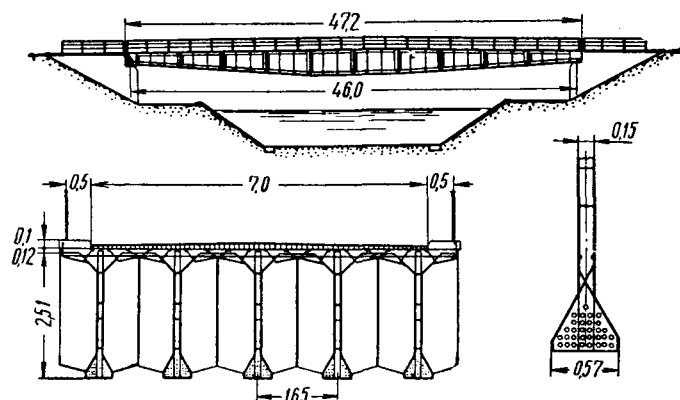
Предварительно напряженный железобетонный мост через канал в Испании
